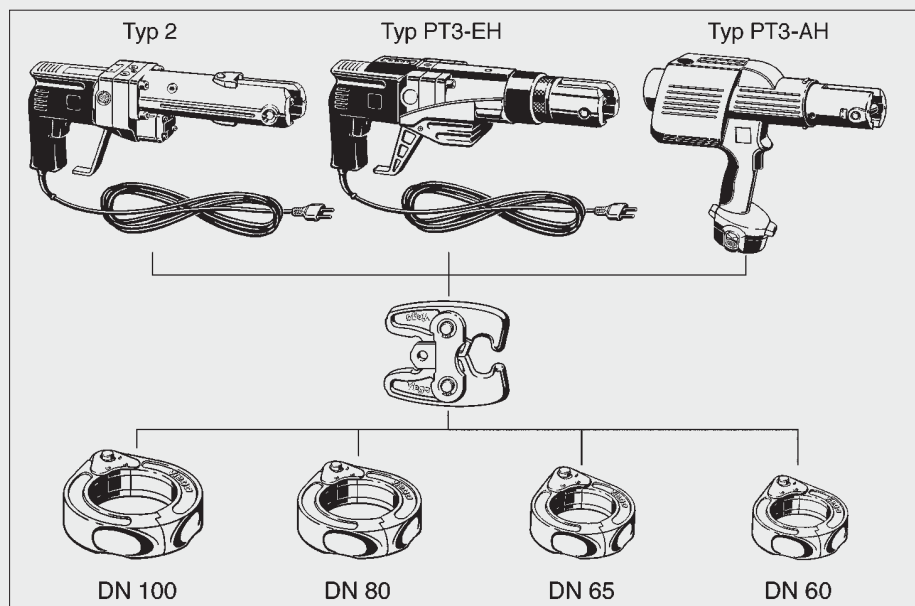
/2: Viega-Systempresswerkzeuge mit Zubehör für XL-Verbinder
